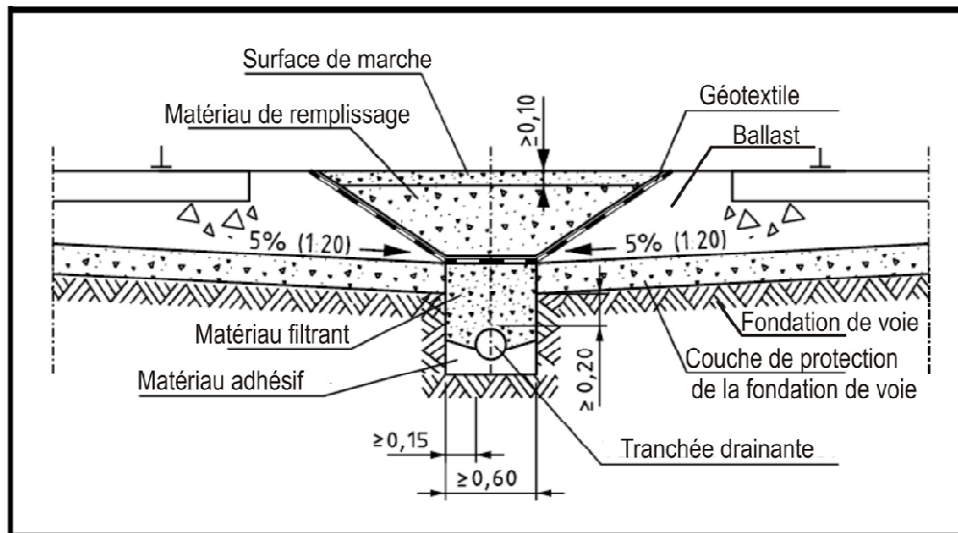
Couche protectrice et système de drainage (DB AG, [18])
